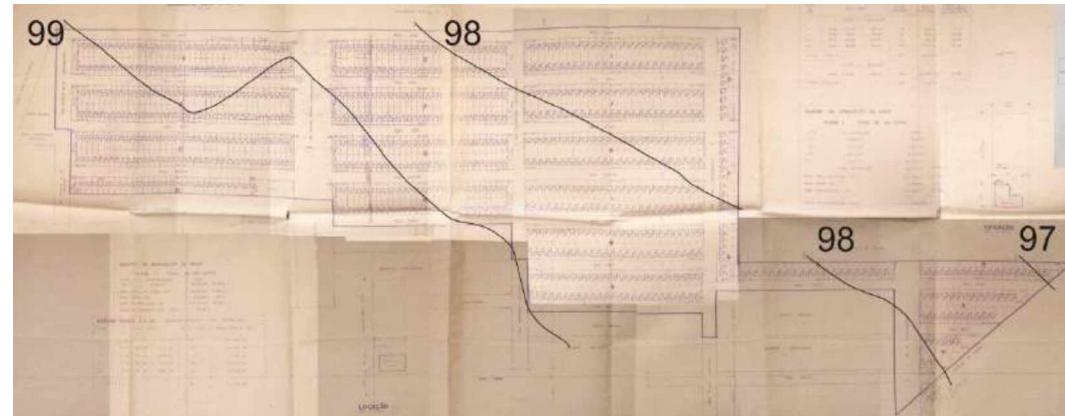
Fotografia da planta original do CHIS Ouro Verde com a demarcação das curvas de nível conforme representadas em projeto. Fonte da planta base: PMU. Adaptação: Autora, 2016.
